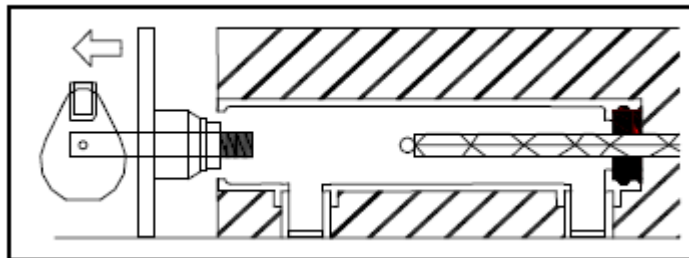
Retiro del moldaje finalizado el curado. (Ref. 10)
